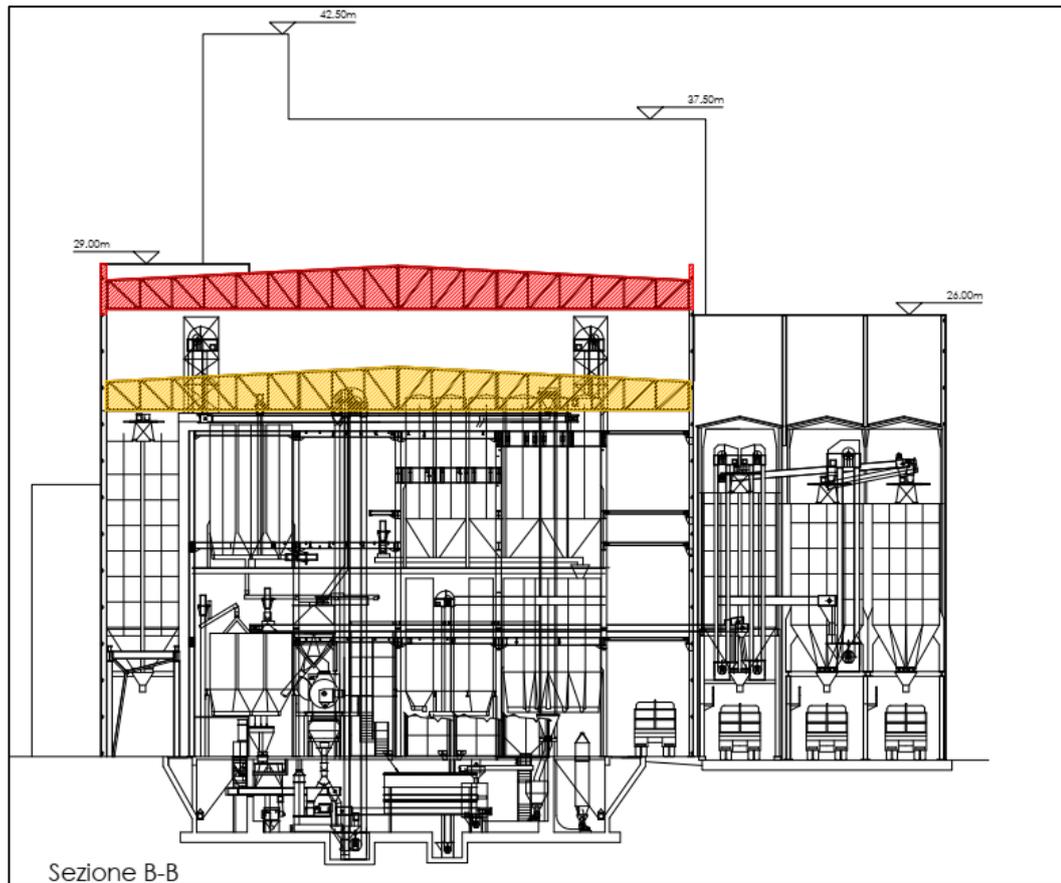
ILLUSTRAZIONE DELL'INSERIMENTO DEGLI IMPIANTI E CONSEGUENTE NECESSITÀ DI INNALZAMENTO DELL'ALTEZZA
